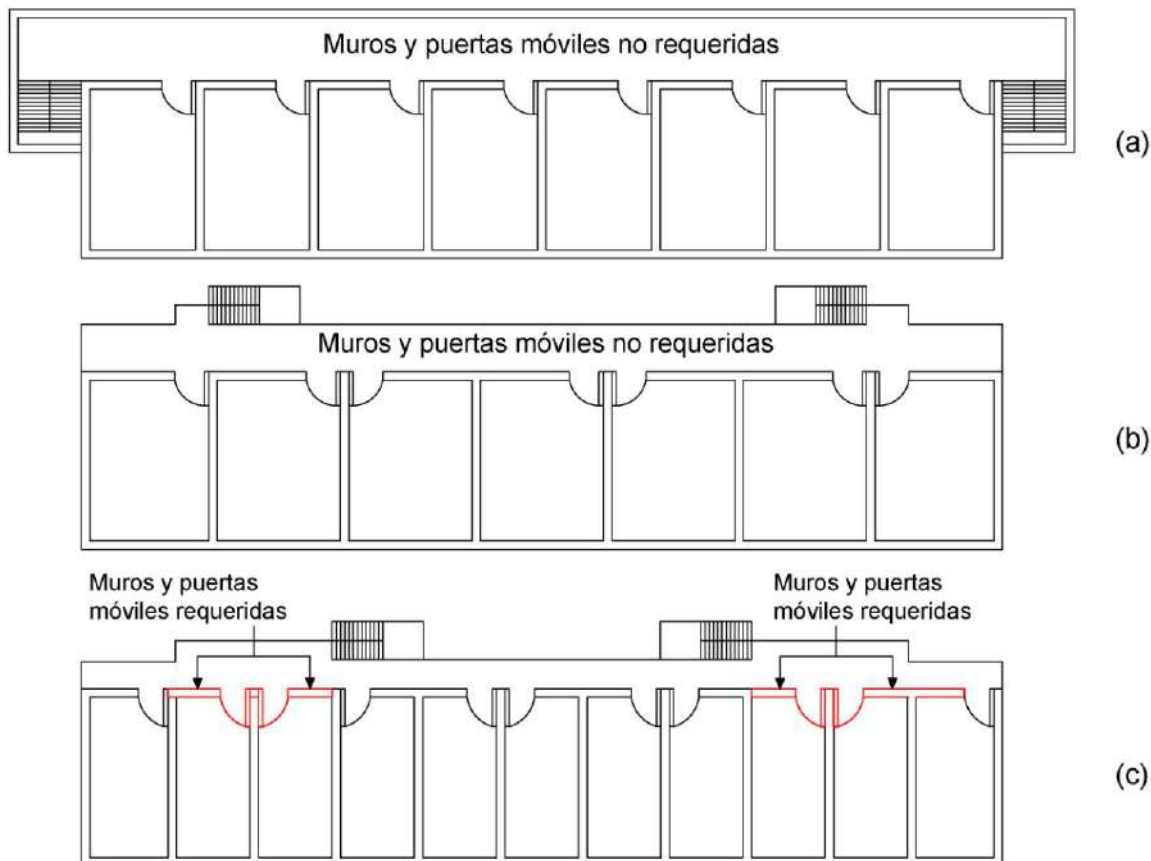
Escaleras abiertas exteriores conectadas por circulación exterior
